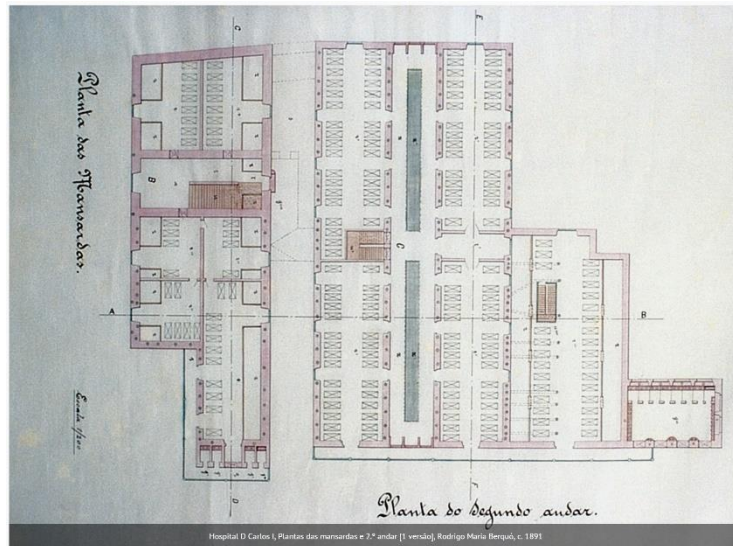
Digitalização de planta de proposta do segundo piso para a construção das enfermarias de apoio ao Hospital termal. Fonte: <http://www.arquitecturasdaude.pt/main/dcarlos.html>
